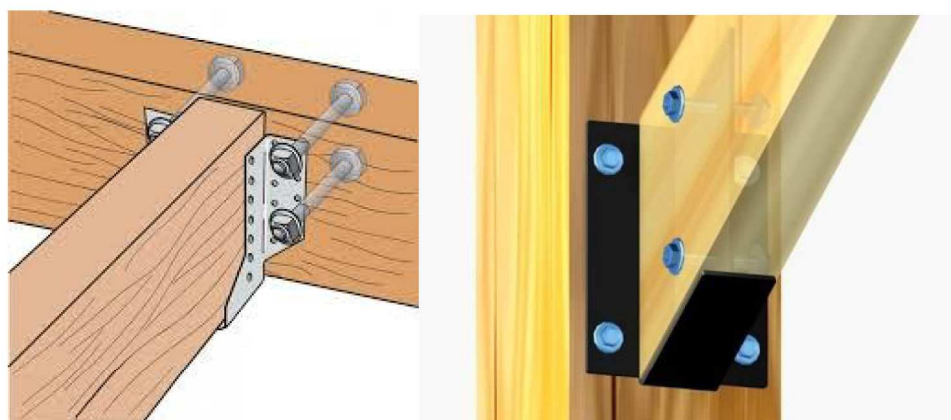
Placas de acero de refuerzo en uniones de los pilotes reforzados.
